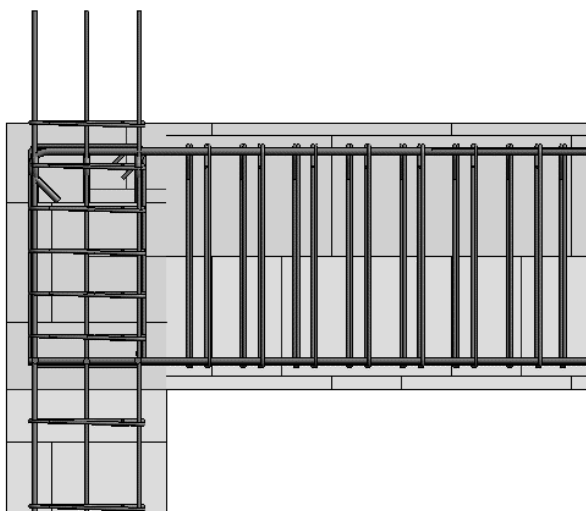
Pormenor de amarração de um pilar armado integrado em Revit a partir do Robot
